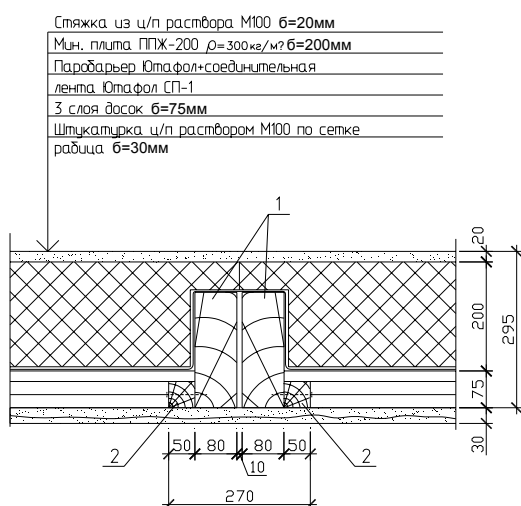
Конструкция чердачного перекрытия (фрагмент) : 1 – деревянная балка перекрытия (80х220), 2 – черепной брусок (50х50)
